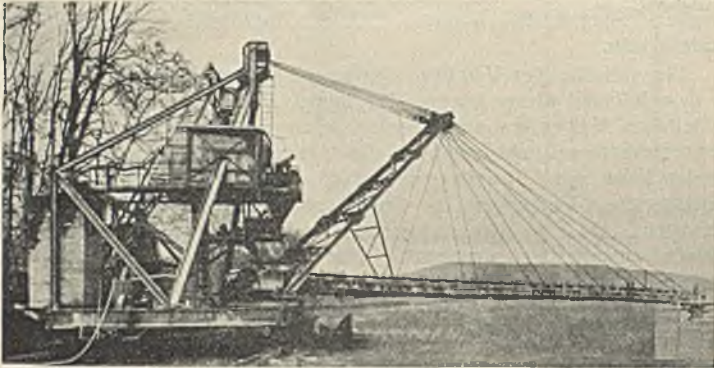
Fahrbare Betonförderanlage mit 4 elektrischen Fahrwerken.
